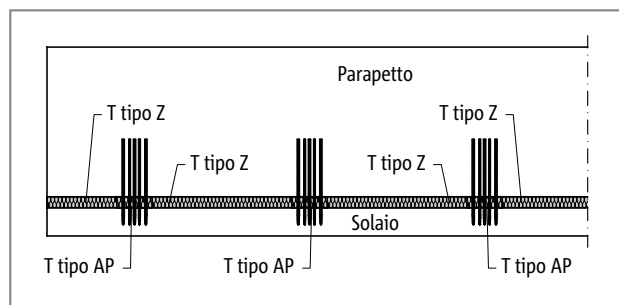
Schöck Isokorb® T tipo AP disposizione verticale: vista parapetto sovrapposto
